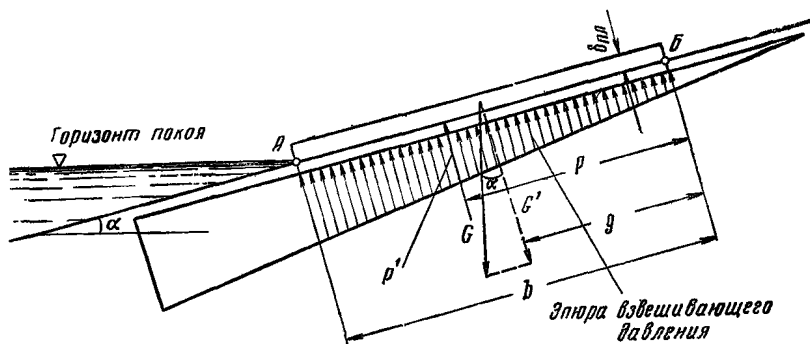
Расчетная схема для определения устойчивости бетонных плит
